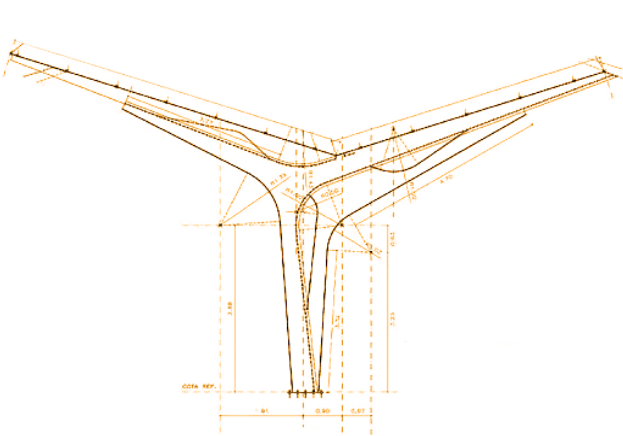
CORTE DE LA ESTRUCTURA
